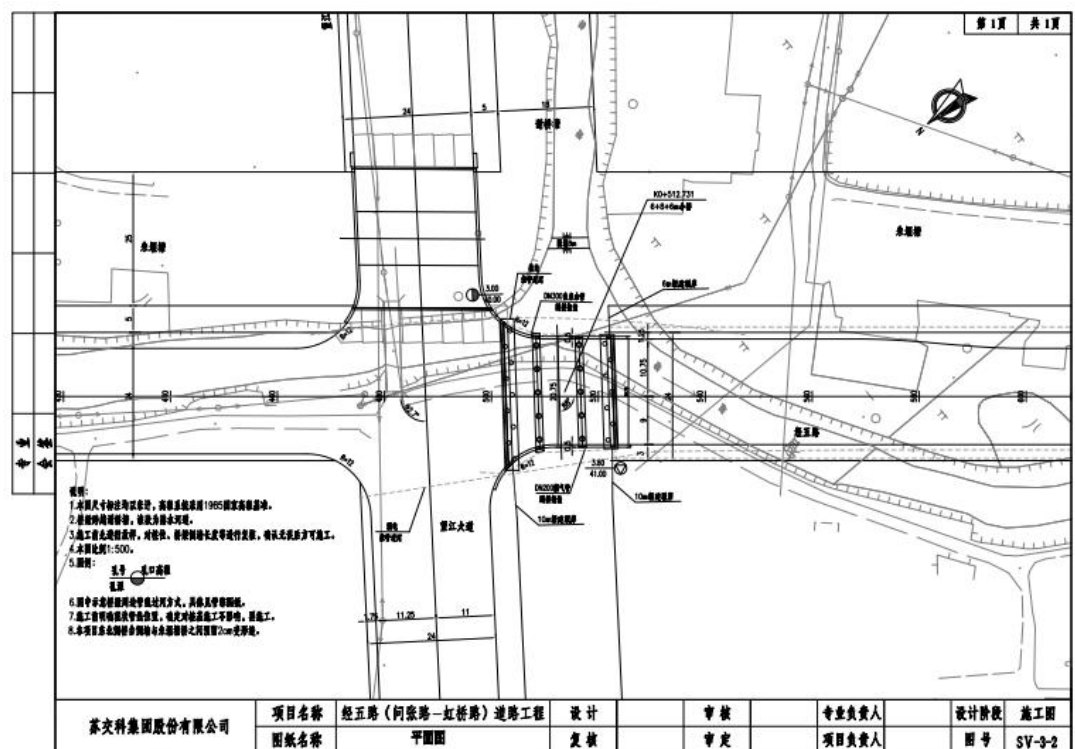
本项目谢桥塘桥梁施工段平面布置图（规划谢桥塘建设完成后再进行本项目桥梁工程）
